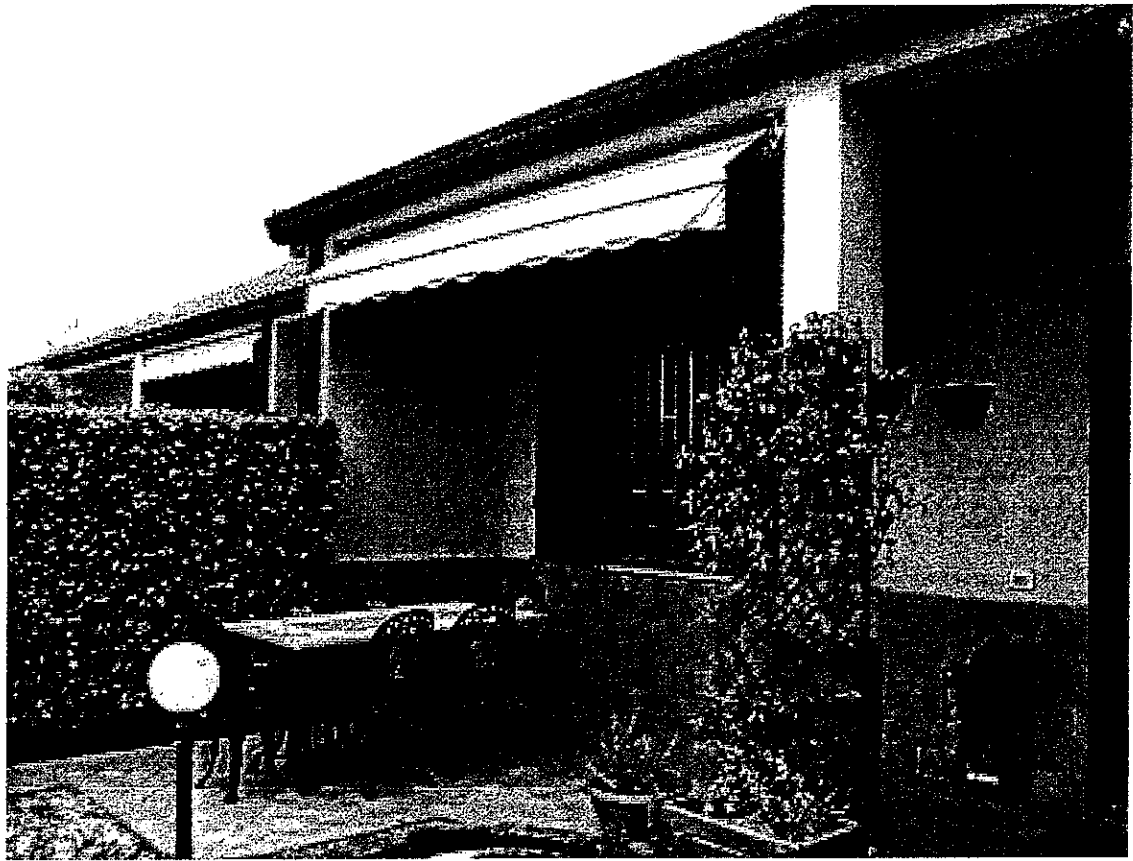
Vista parziale del porticato (sullo sfondo la finestra della camera matrimoniale).
